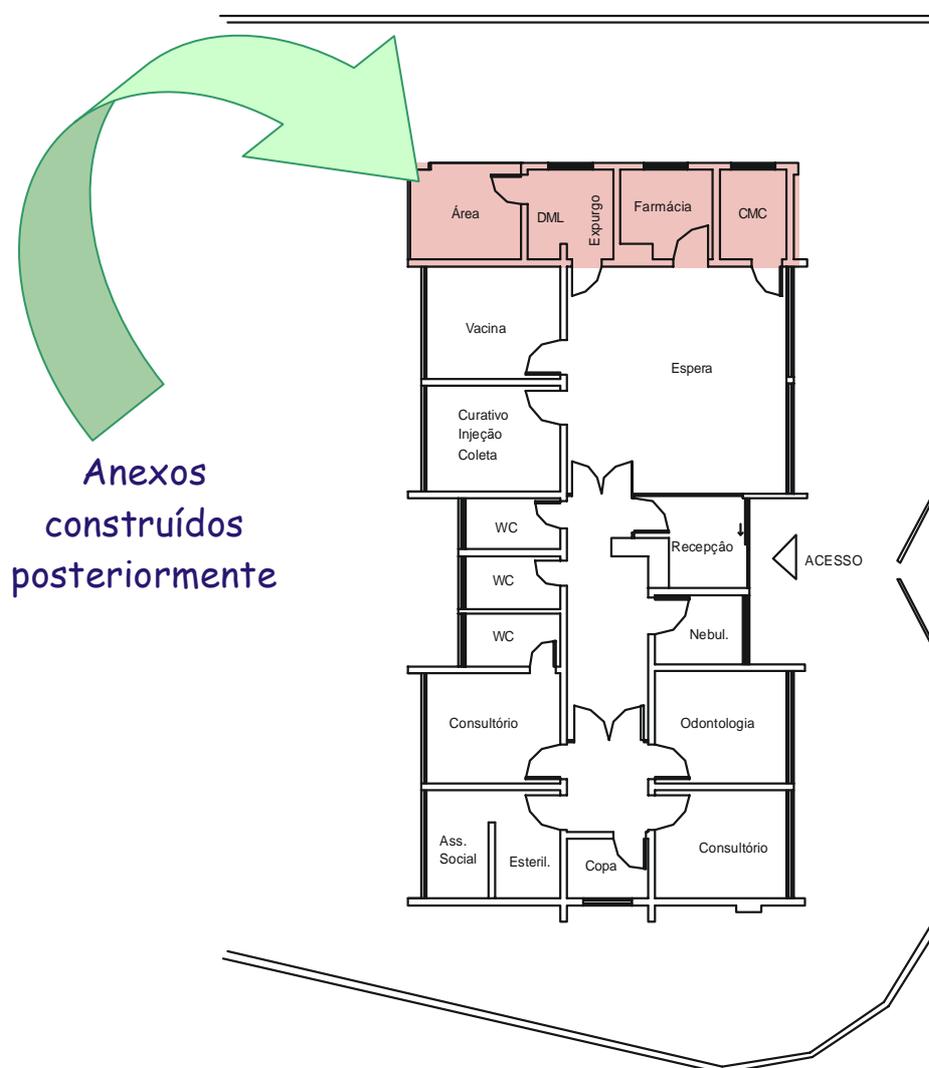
Planta baixa da antiga UBS Milho Branco já com as alterações ocorridas em 1996.
